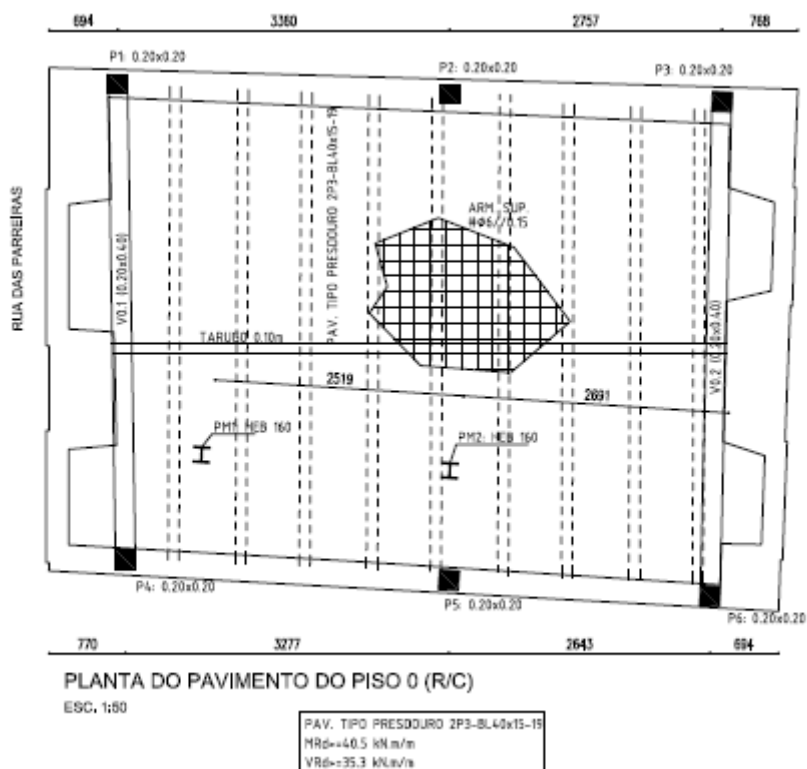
planta do pavimento do piso 0 (Nunes, projeto de estabilidade, 2016)
